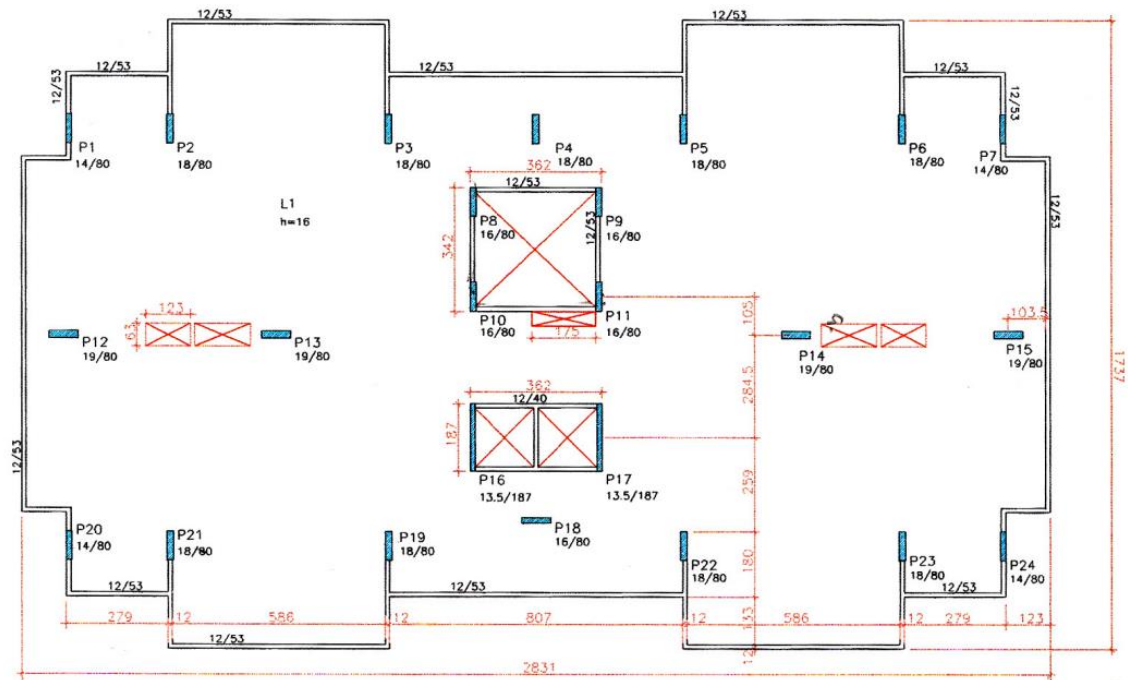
Planta baixa do primeiro exemplo (MARTINS, 2003) – cotas em cm
